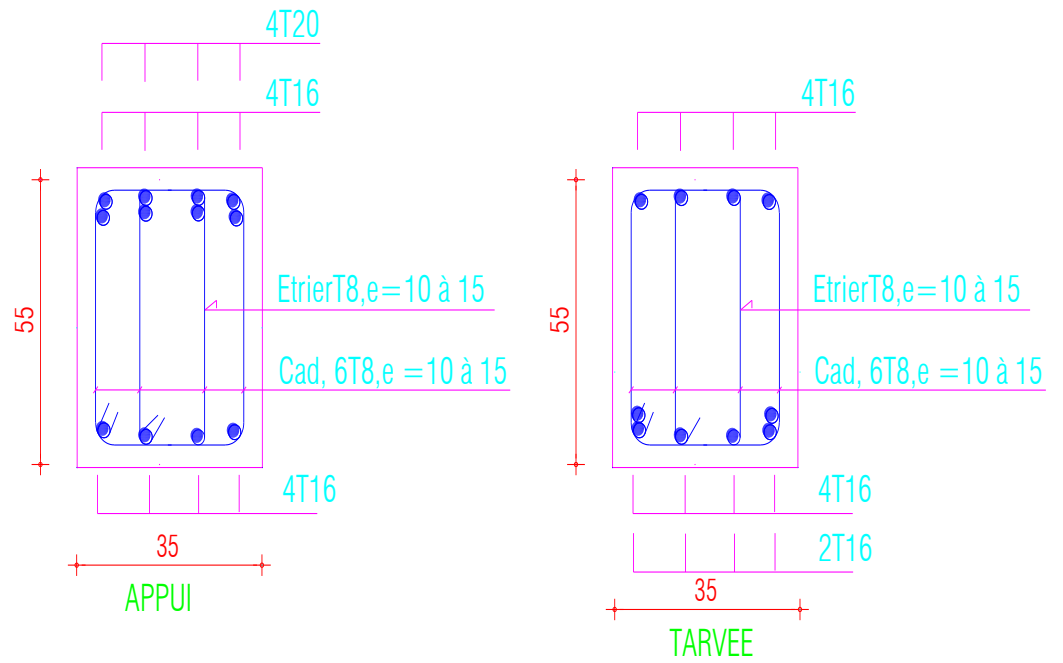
Ferrailage poutre principale liée avec voile (35x55)
